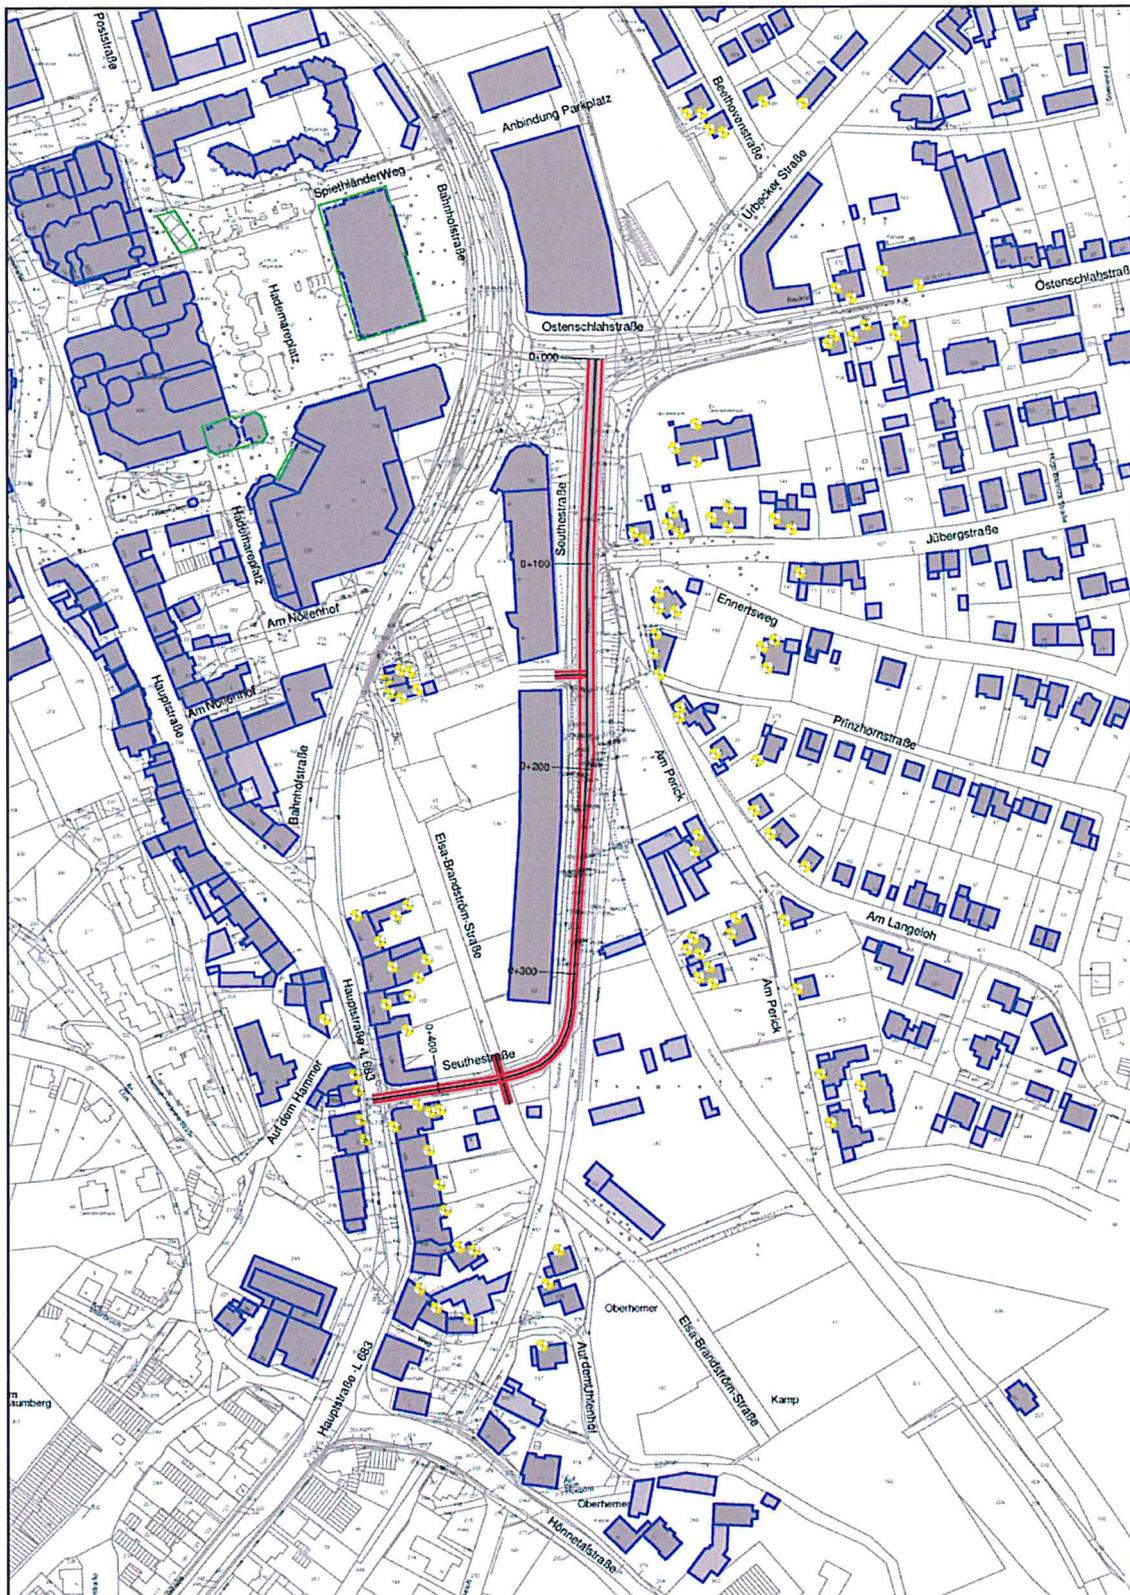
Lageplan und Immissionsorte der Seuthestraße
